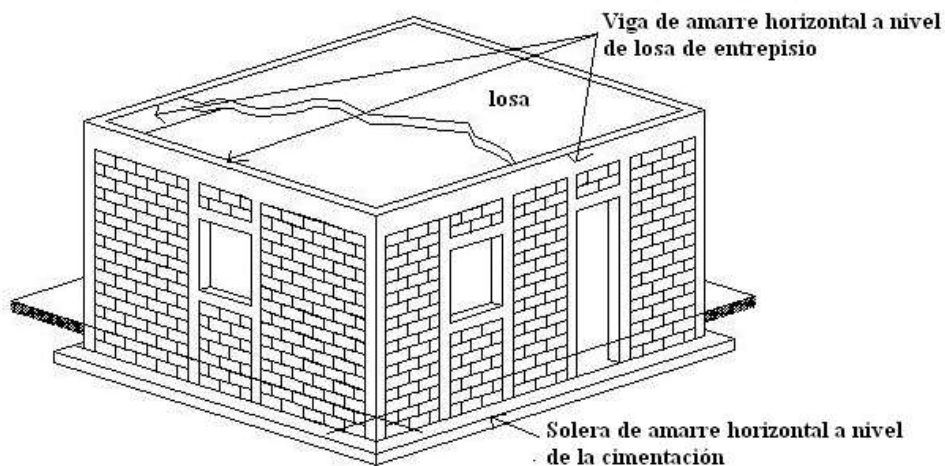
Vigas o Soleras de amarre en viviendas de dos plantas
